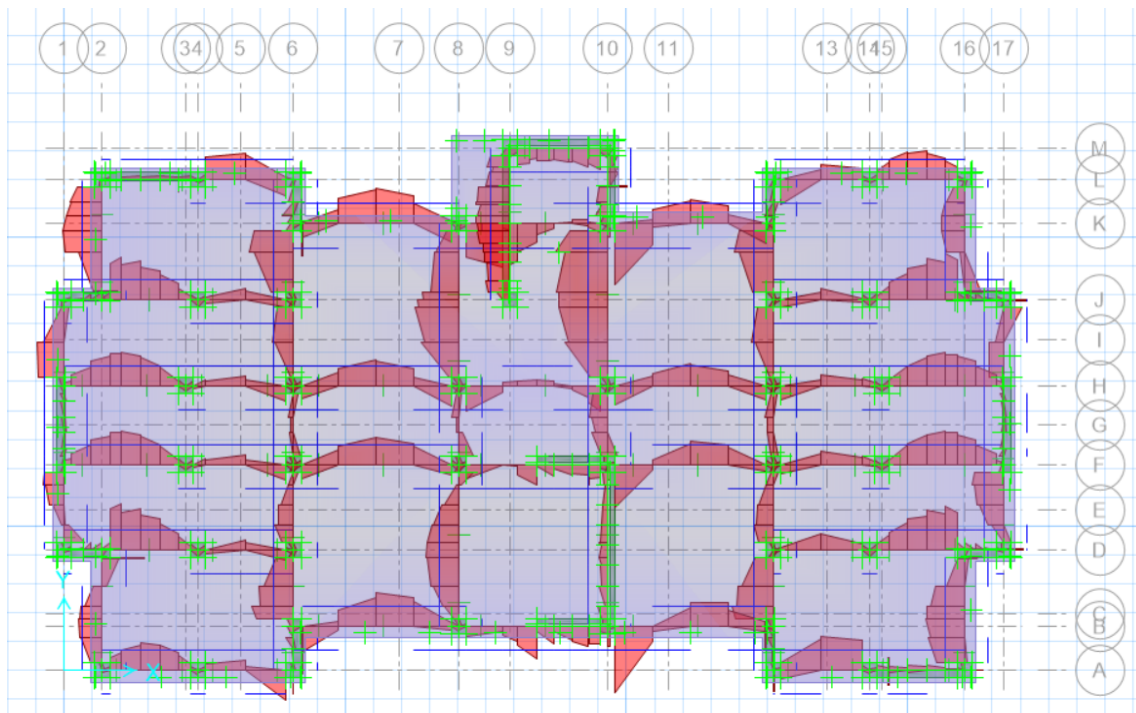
Distribución de acero longitudinal en vigas de cimentación Sistema Dual - Edificio Blesser. Fuente: Elaboración Propia.
